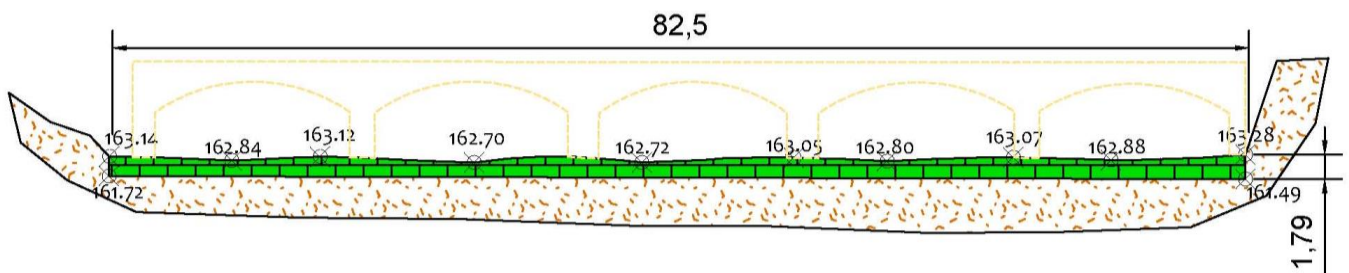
Plan topographique du seuil de la RD 20 à Buisson – Zoom sur le seuil
